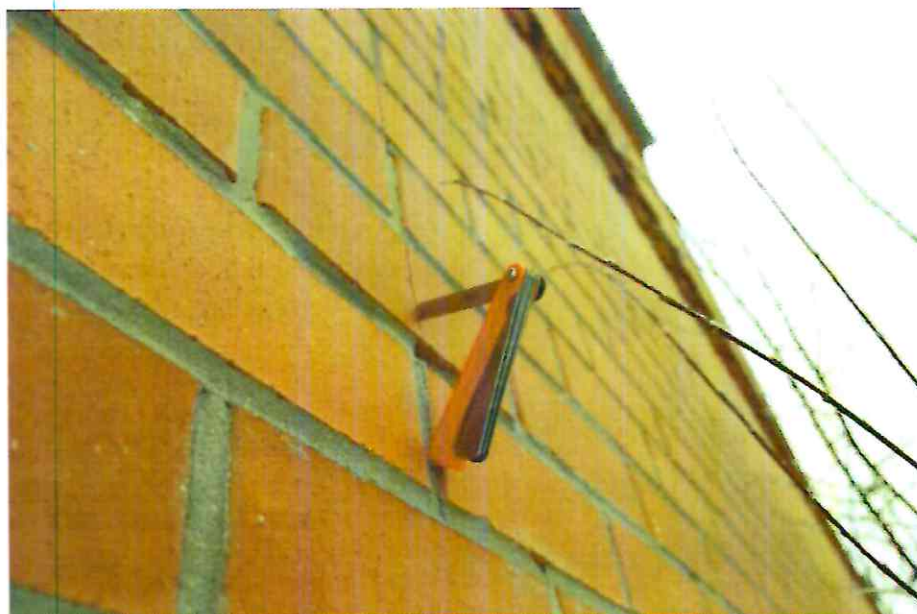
Трещина до 0,5 мм по фасаду.
